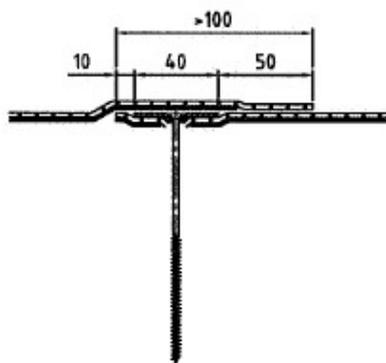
joint longitudinal dans le cas d'un système fixé mécaniquement
